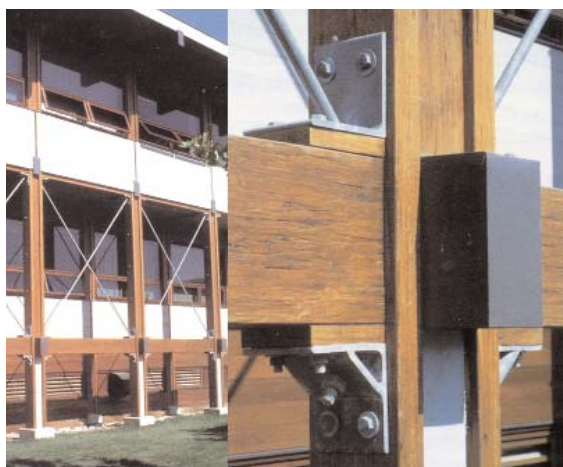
Edificio per uffici, Vancouver (Canada), Henry Hawthorn, 1993. Vista d'insieme e dettaglio del sistema di attacco pilastri, travi secondarie in Parallam e tiranti di controventamento. Processo di produzione tipo del Parallam: sfogliatura del tronco, essiccazione dei fogli, taglio longitudinale dei fogli, selezione strisce, applicazione del collante, assemblaggio delle strisce, pressaggio a microonde, rifinitura, taglio in senso longitudinale, piallatura, controllo della qualità e marchiatura, spedizione.
